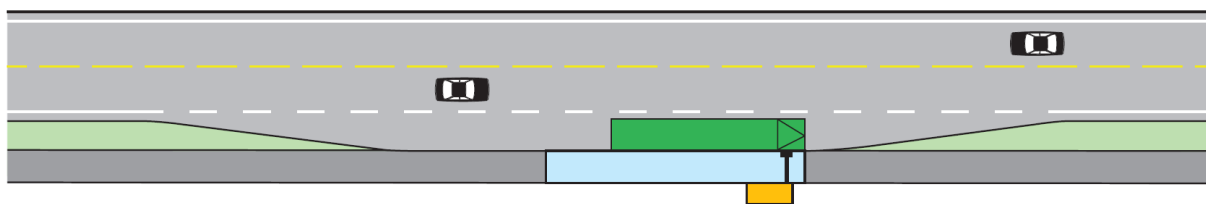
Figur 13 viser prinsippskisser for utforming av busslommer. Valg av løsning må stedstilpasses.
